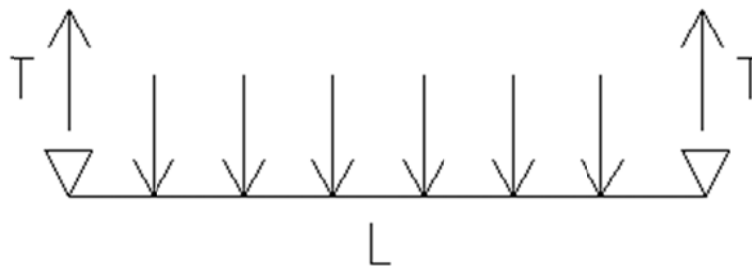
Schema statico della trave equivalente alla spalla sul piano orizzontale
